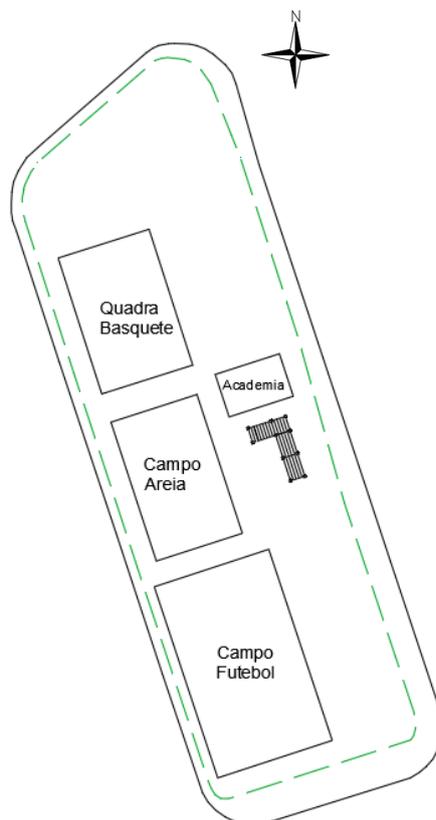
Planta baixa do local de implantação do pergolado. Fonte: Elaborado pelos autores.
